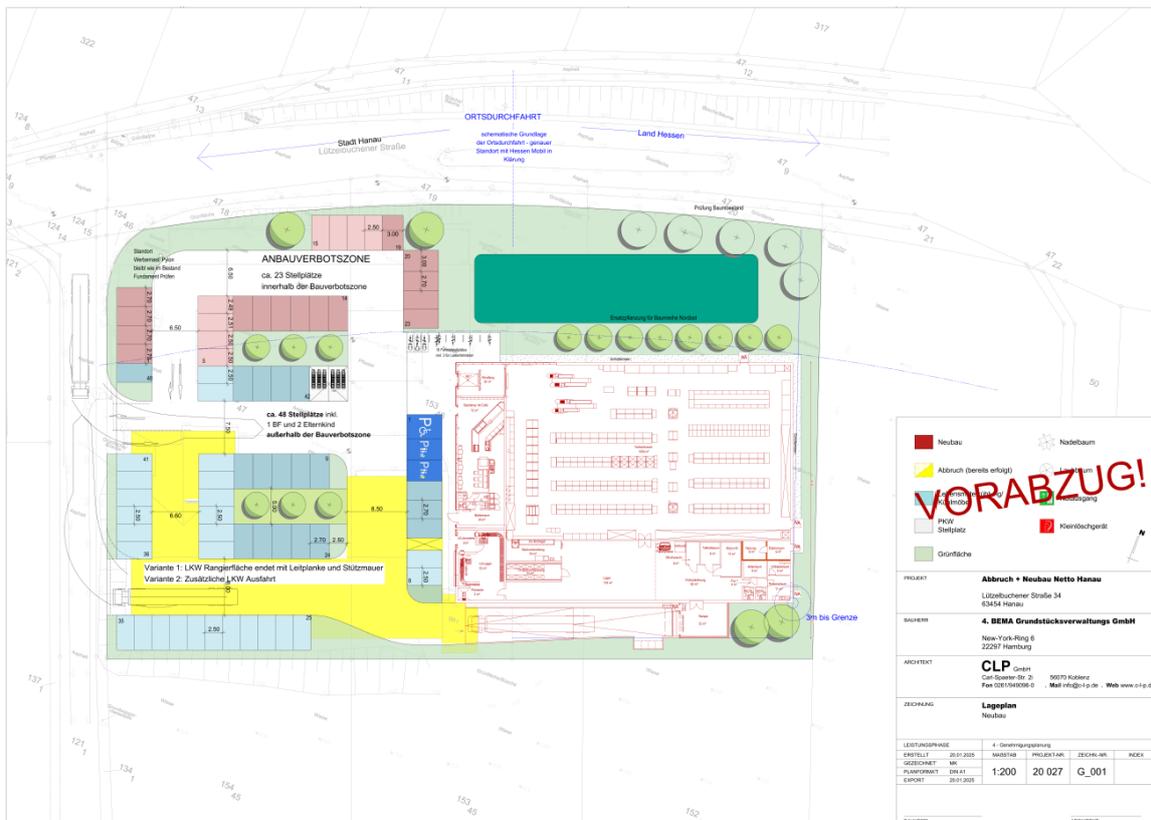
Vorabzug Lageplan des Neubaus Netto Hanau mit Ausgleichsfläche (CLP GmbH 2025)
